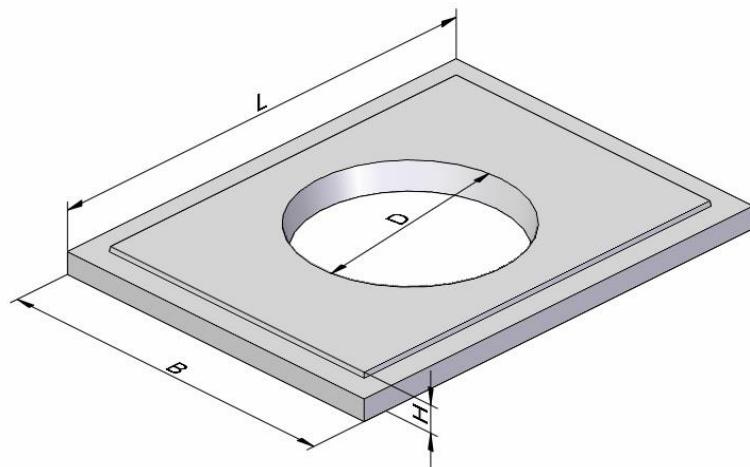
Вид снизу на плиту перекрытия колодца ККСр-1-10(80).
